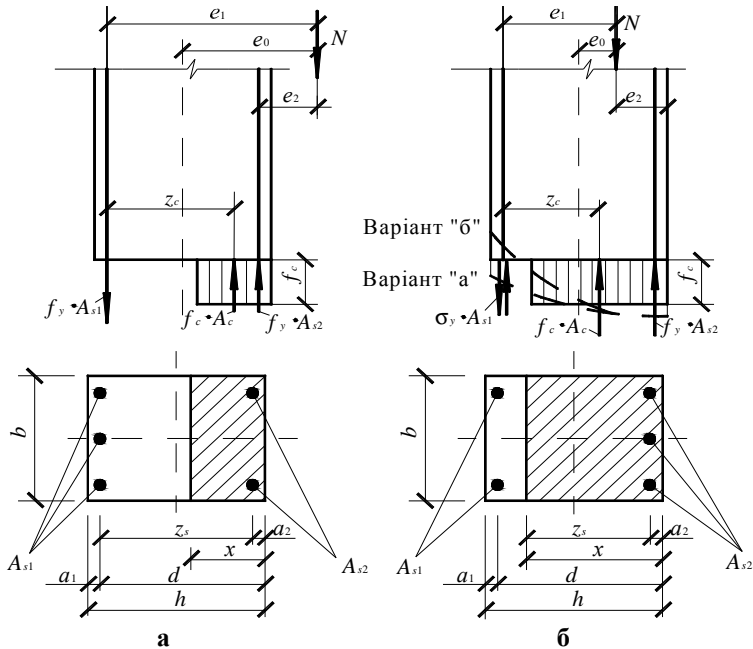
Розрахункова схема перерізу нормального до поздовжньої осі позациентровою стиснутого елемента:
